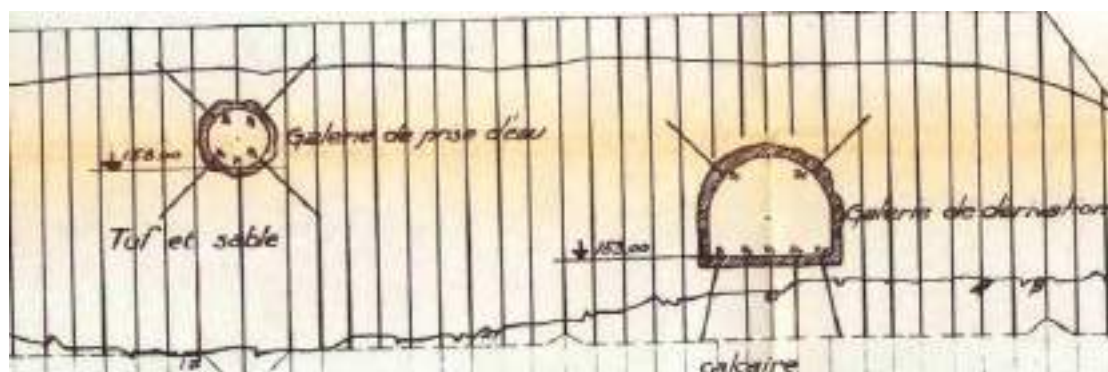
Vue en coupe des galeries (extrait plan de 1934)
